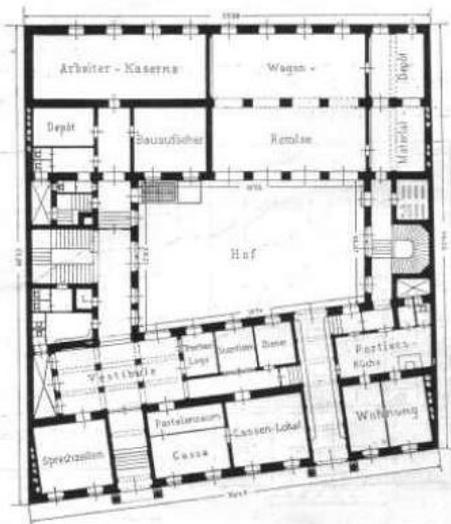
Erdgeschossgrundriss der Zentrale I in der Dreihufengasse
